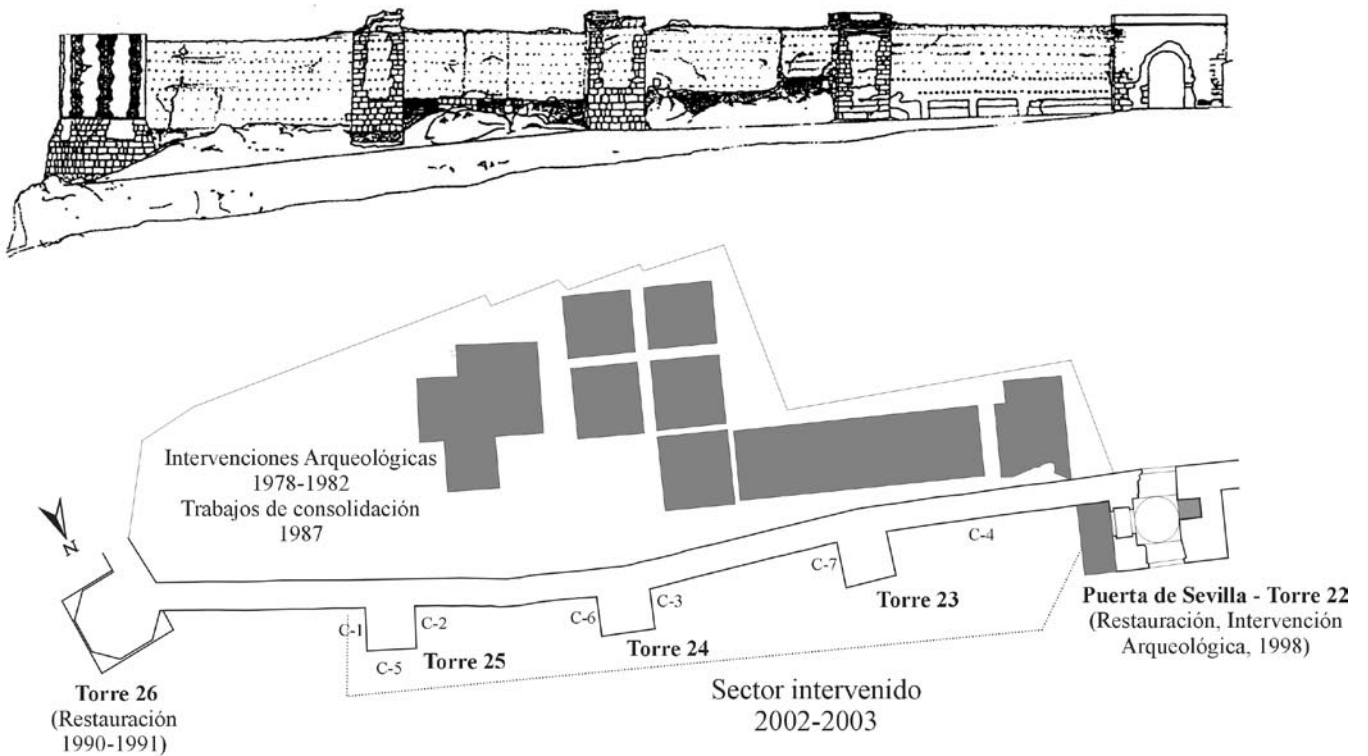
Alzado norte y planta del Tramo de Murallas Puerta de Sevilla - Torre 26. En sombreado cortes estratigráficos realizados en intervenciones anteriores.
